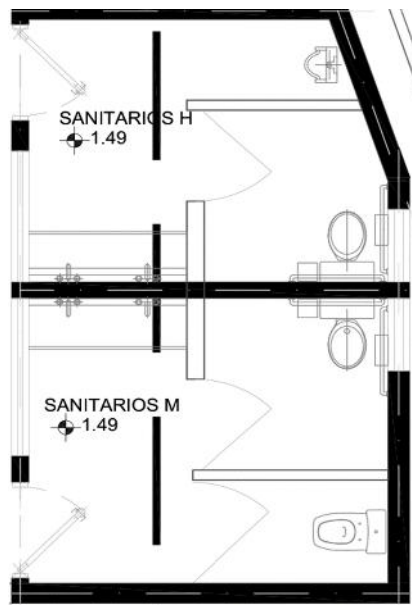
Vista de planta de la infraestructura que se colocará en la estación de servicio.
